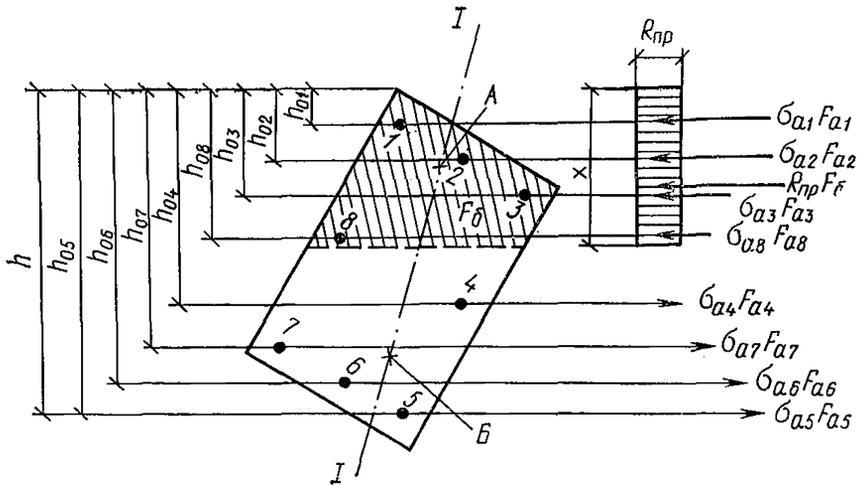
Схема усилий и эпюра напряжений в сечении, нормальном к продольной оси железобетонного элемента, в общем случае расчета по прочности
